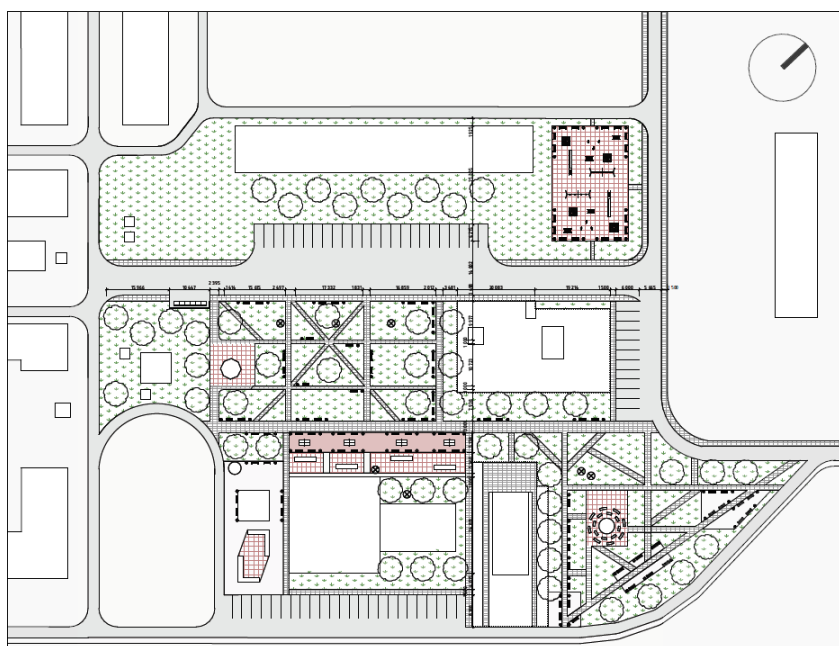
Концептуальный проект благоустройства сквера Самарского резервуарного завода.
